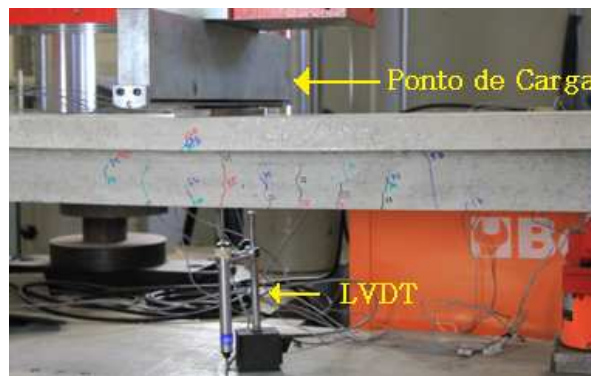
LVDT colocado sob a viga, no ponto de aplicação de carga
